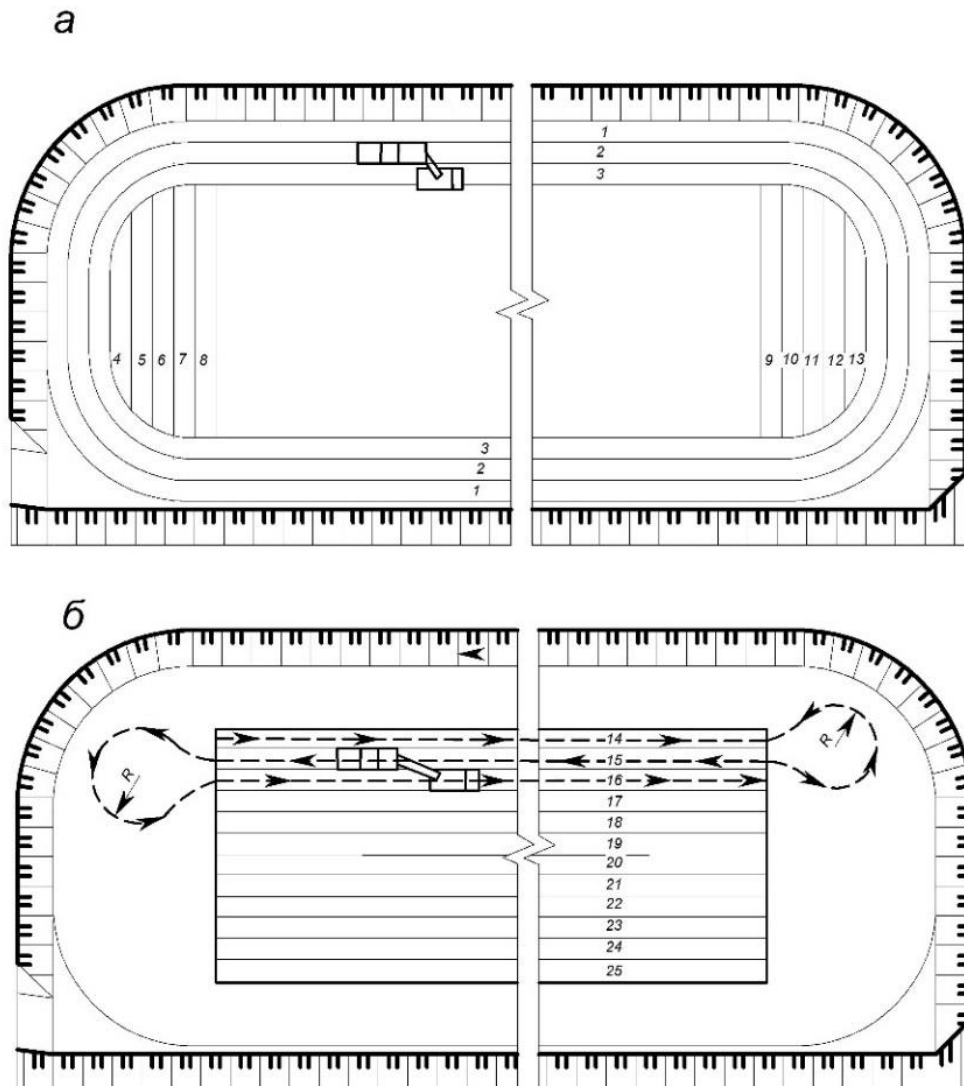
Схема роботи комбайна з розворотом і фрезеруванням в зворотному напрямку: а – врубові виробки; б – основні виробки
